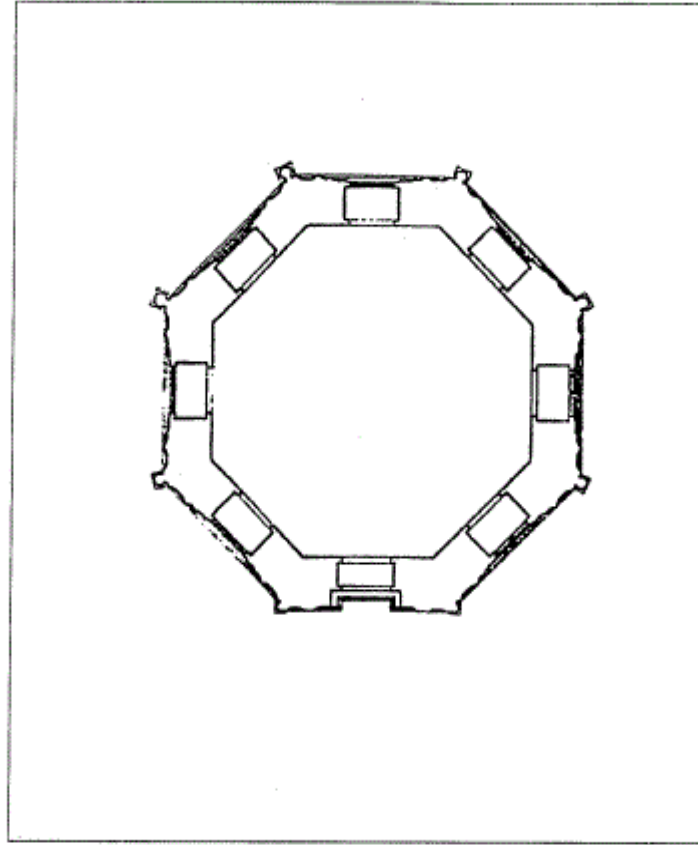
مسقط أفقي لتربة خاصكى حرم بجمع السليمانية بإستانبول (عن : اصلان
